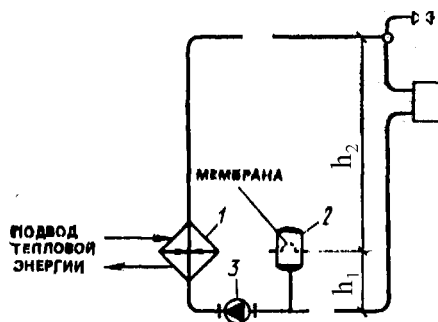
18. Схема присоединения закрытого расширительного бака
